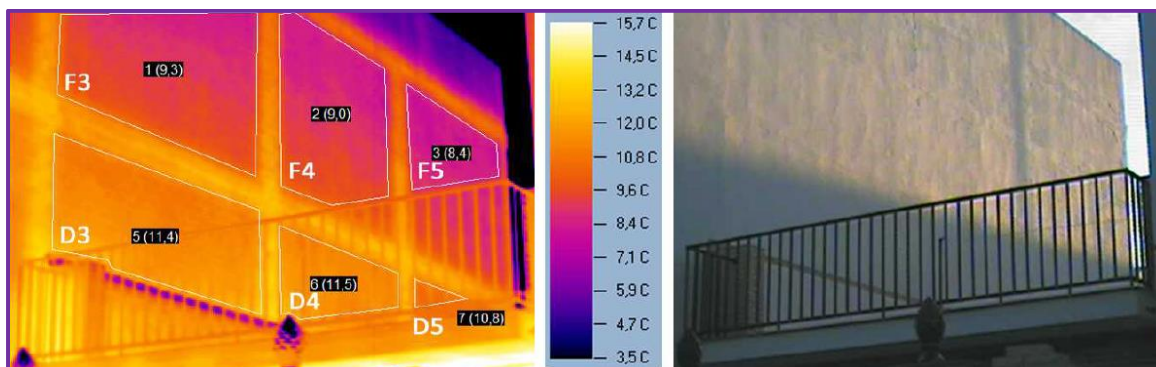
Termografía de la fachada sur (Fig. 4.32 de Facchini, 2014)
